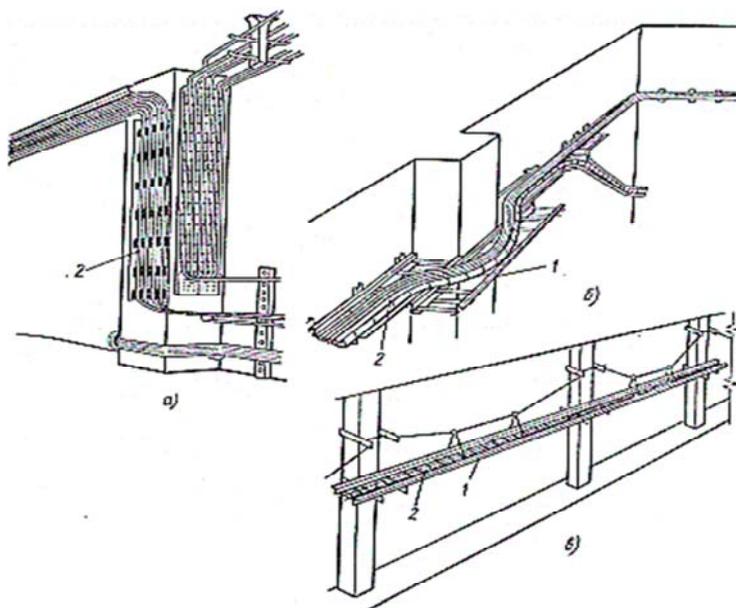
Выполнение открытой электропроводки на лотках:
